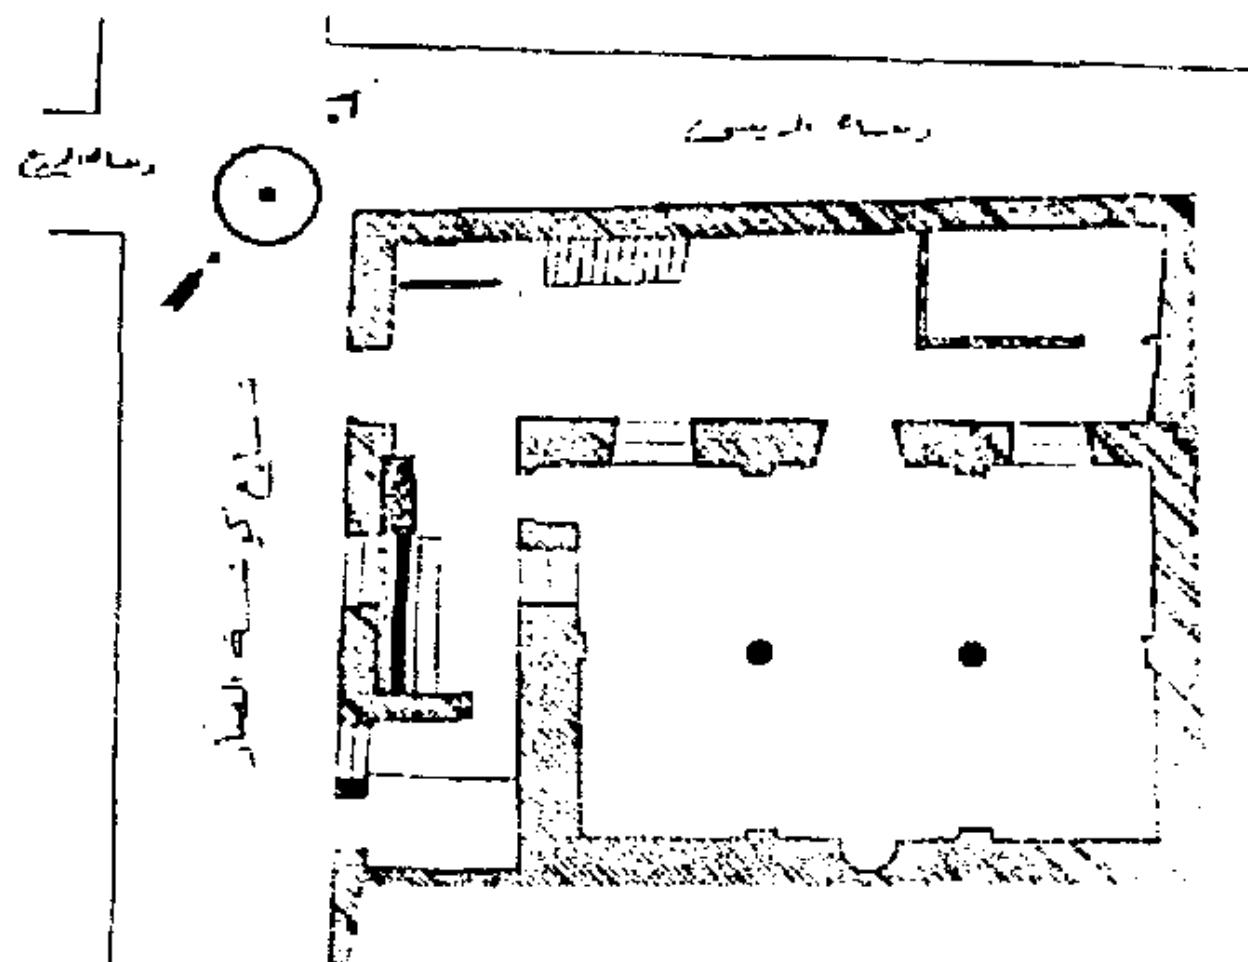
مسقط أفقى لجامع در غوت باشا عن الموسوعة (الجزء الأول).
